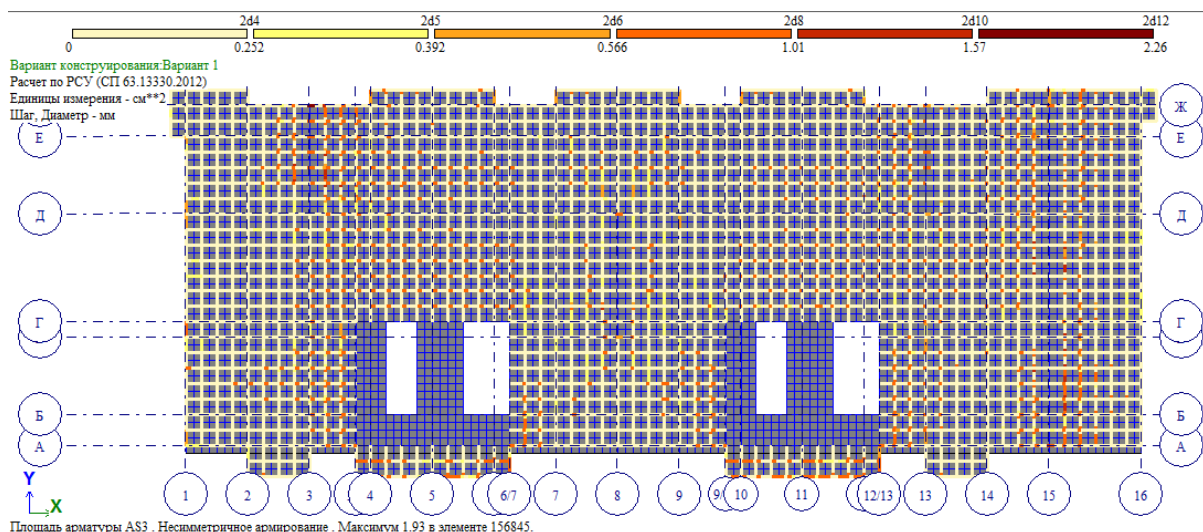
Площадь продольной арматуры у боковой грани балок (слева).
